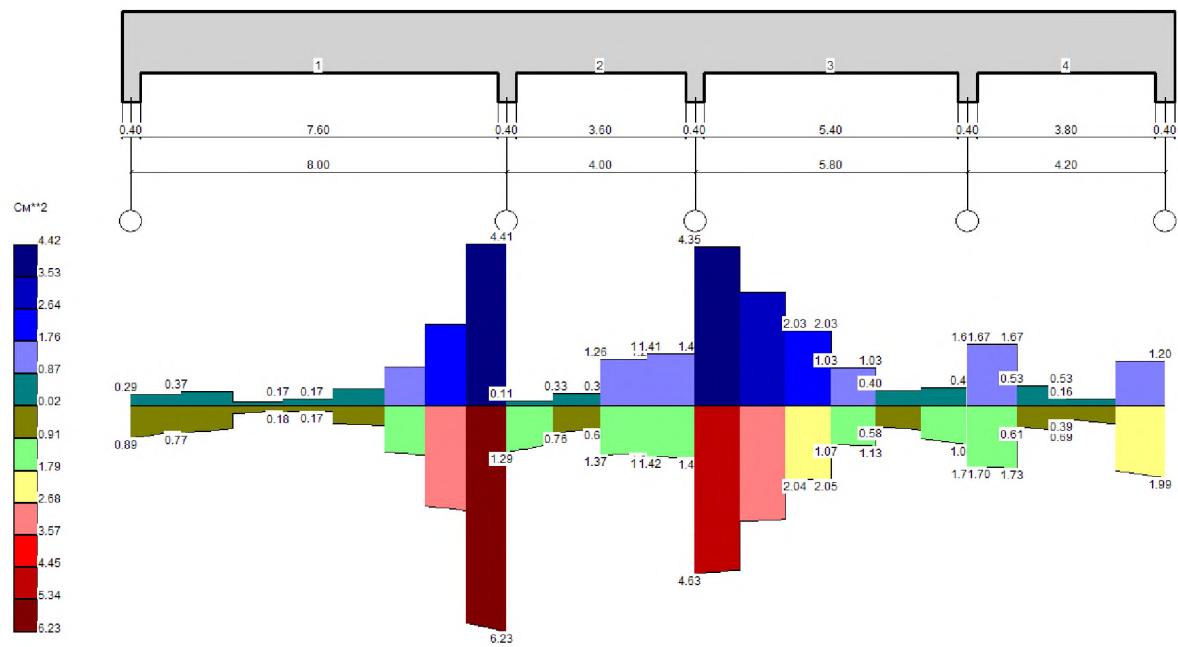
Балка № 1. Епюра поперечного армування
